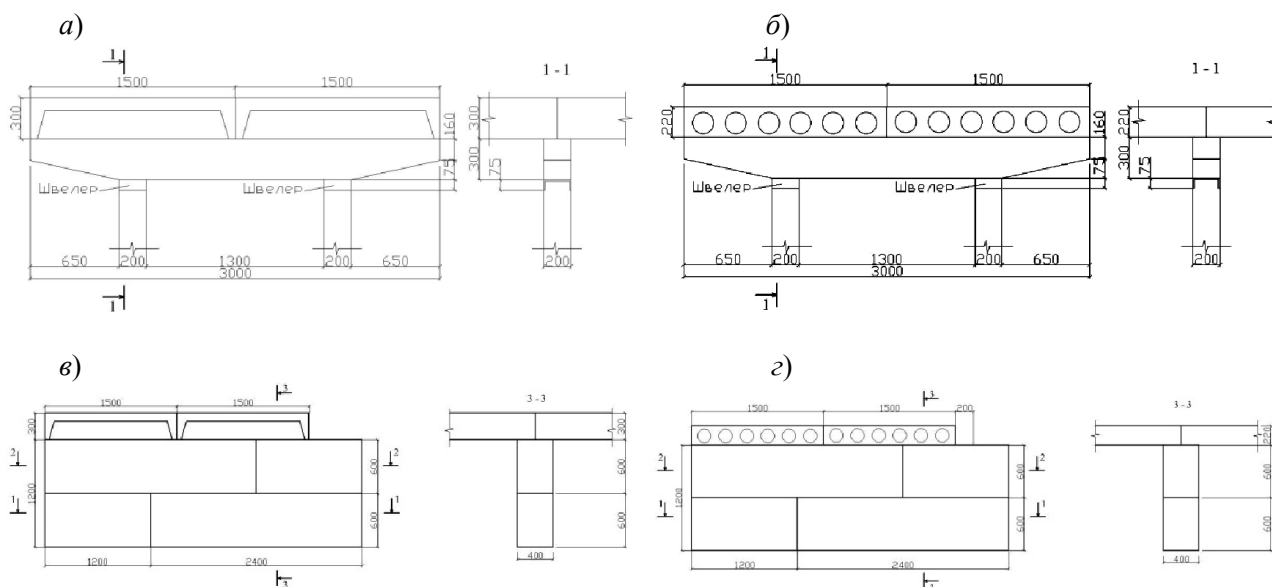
Конструкція високих пасажирських платформ: опори – залізобетонні стояки та ригель (а, б) або блоки бетонні для стін підвалів (в, г); покриття – залізобетонні ребристі плити (а, в) або залізобетонні багатопустотні плити (б, г)
